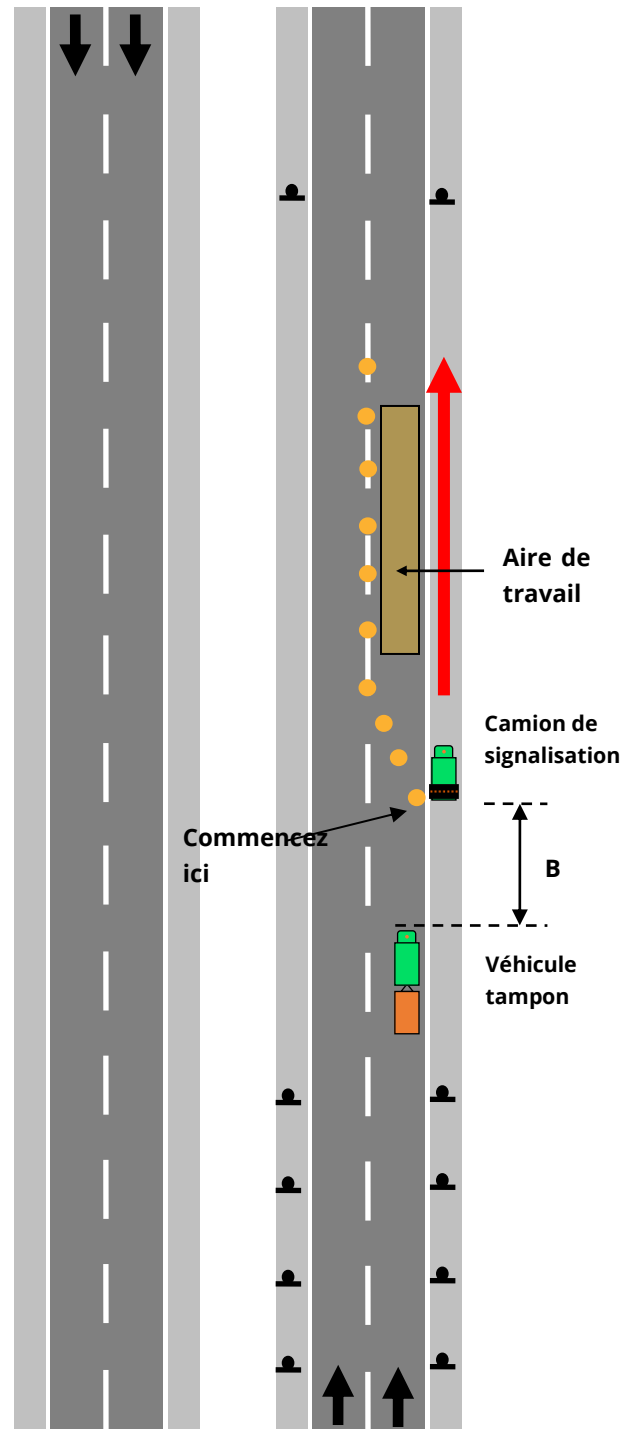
Installation pour la fermeture d'une voie (routes à voies multiples)
